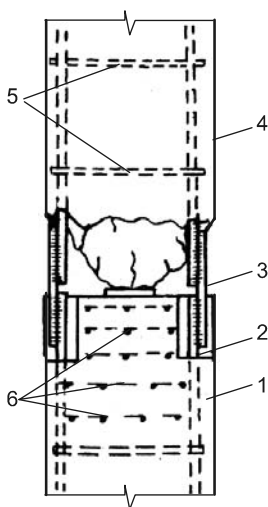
Дефектный стык колонны, приведшей к обрушению здания (не замоноличен бетонный стык): 1 — колонна цокольного этажа; 2 — продольная арматура; 3 — стыковые накладки; 4 — обрубленная колонна первого этажа; 5 — поперечная арматура; 6 — часто расположенные арматурные сетки в оголовке колонны
